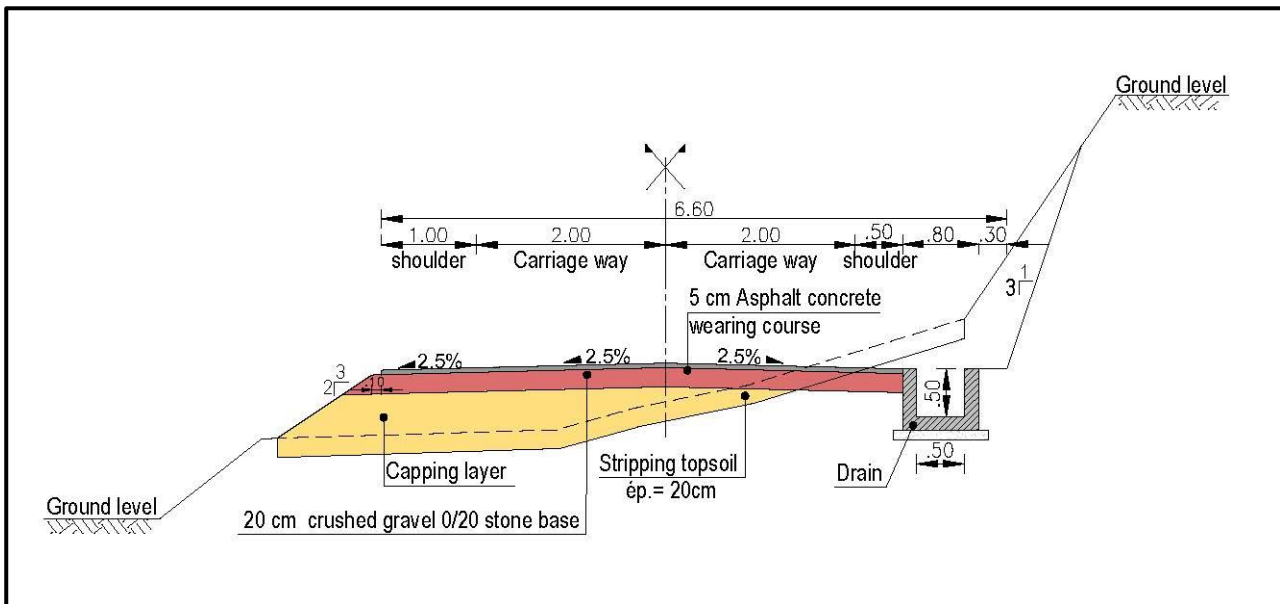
Secção transversal típica 2- Estrada de acesso à ponte Brigoma
